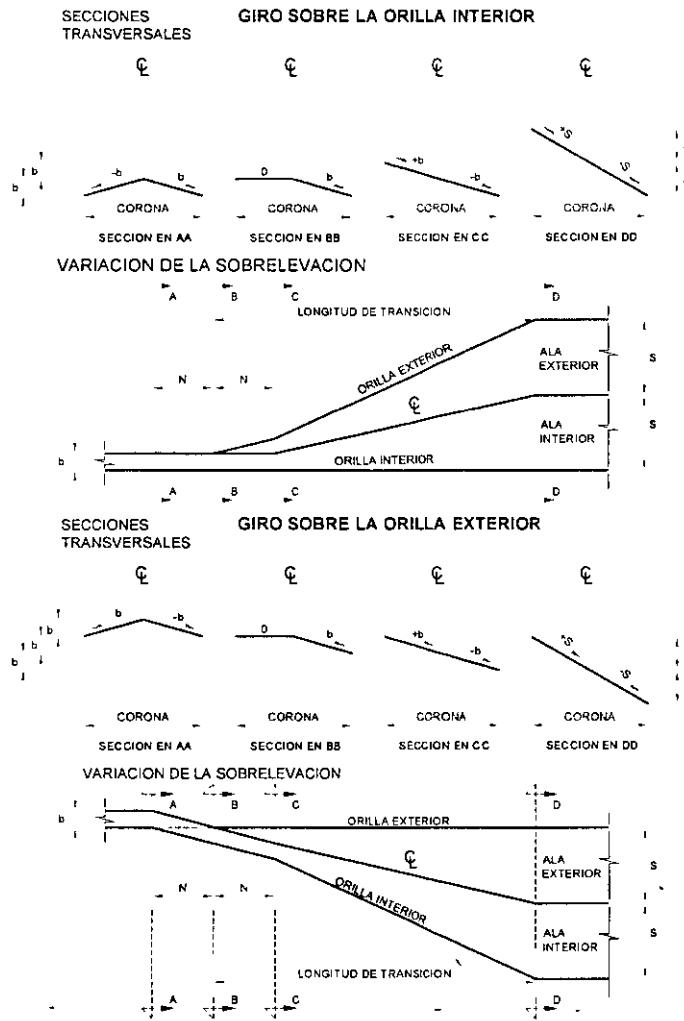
TRANSICION DE LA SECCION TANGENTE A LA SECCION EN CURVA GIRANDO SOBRE UNA ORILLA DE LA CORONA
